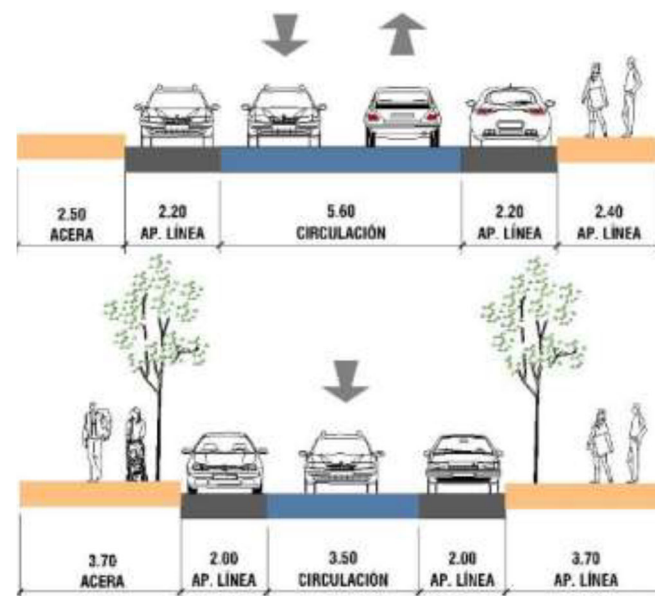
Sección actual y sección propuesta tipo. Fuente: DOYMO.
